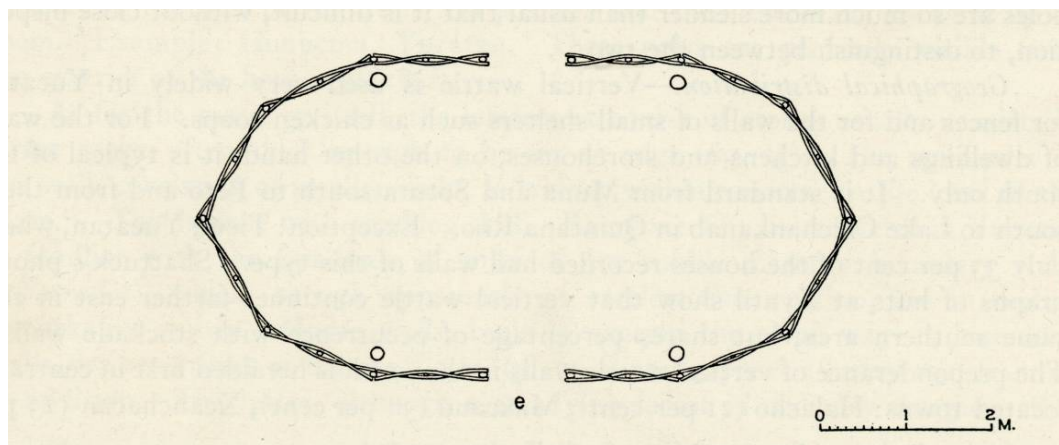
Plano de una casa con paredes de zarzo horizontal. Tomado de Wauchope 1938: Figura 24e.
